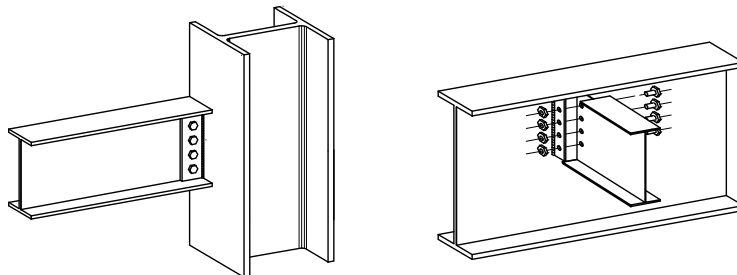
Exemples d'assemblages à goussets d'âme
